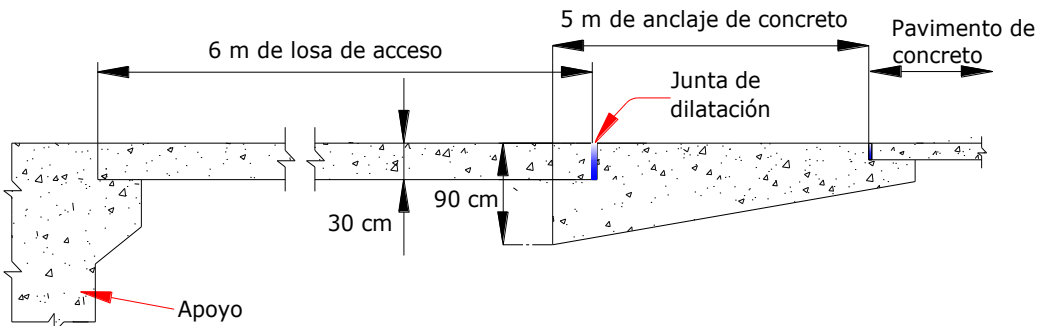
Losa de acceso de 6 m y continuación con un anclaje de concreto de 5 m
